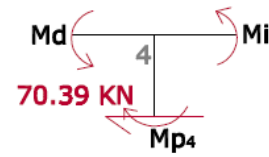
Cortantes en pilares del pórtico PY4 de la planta cubierta.
